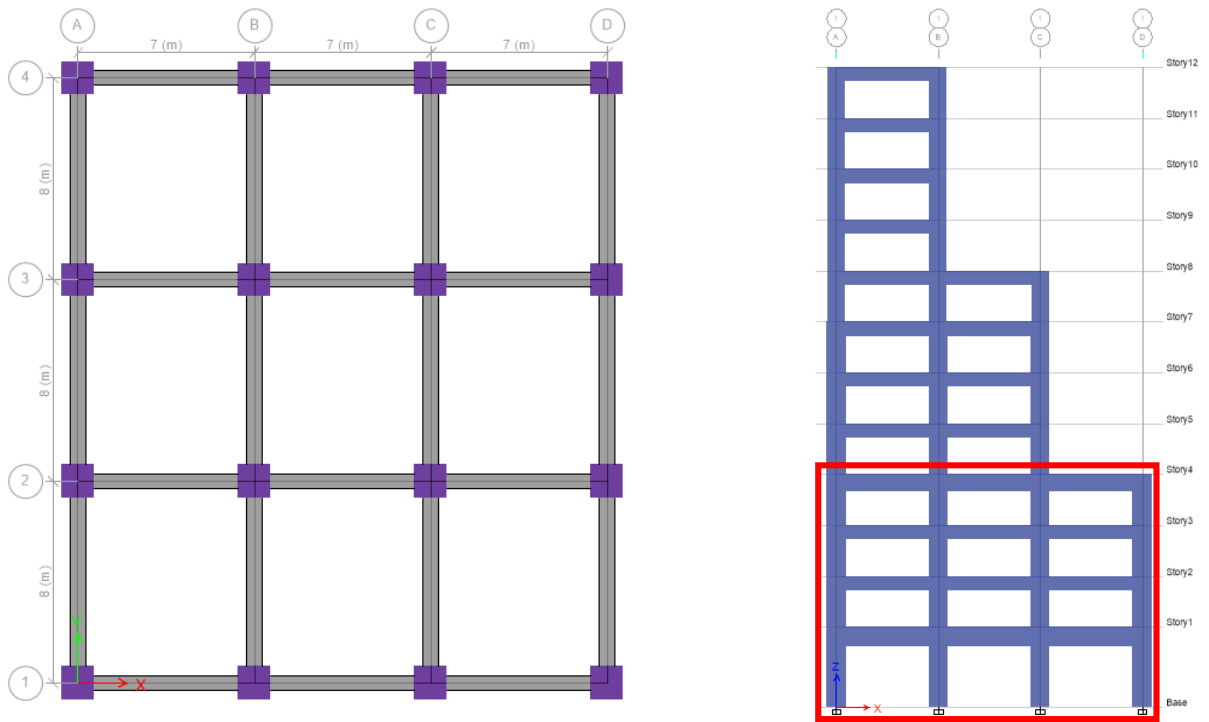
PLANTA DEL NIVEL 1 AL NIVEL 4
